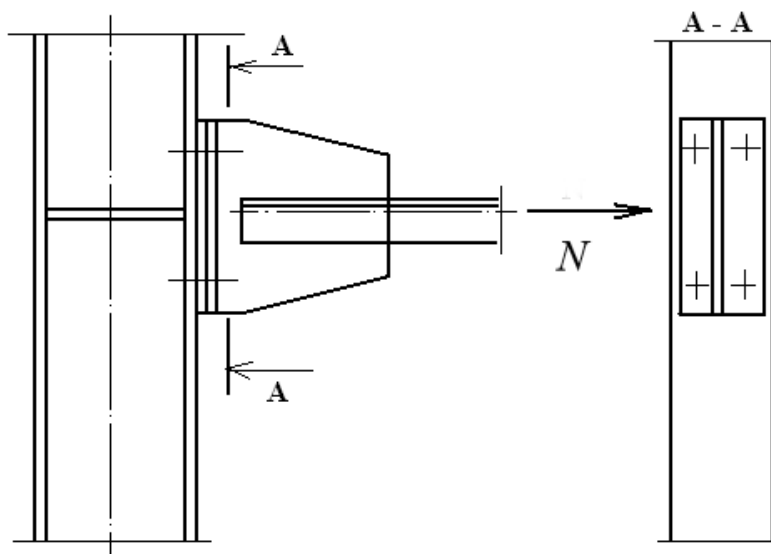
Схематичное изображение соединения верхнего пояса стропильной фермы к колонне к примеру 2
